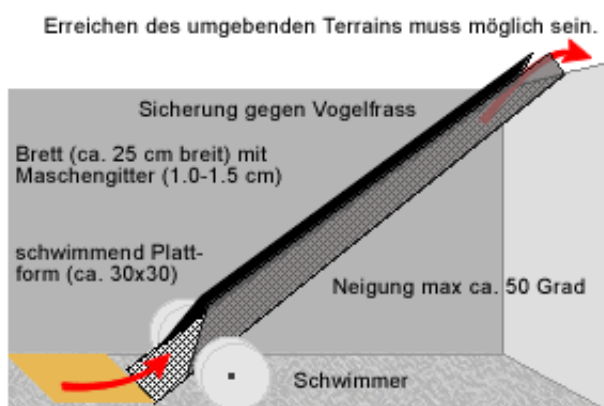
Rampe de sortie pour les bassins proposée par Bauen-tiere
